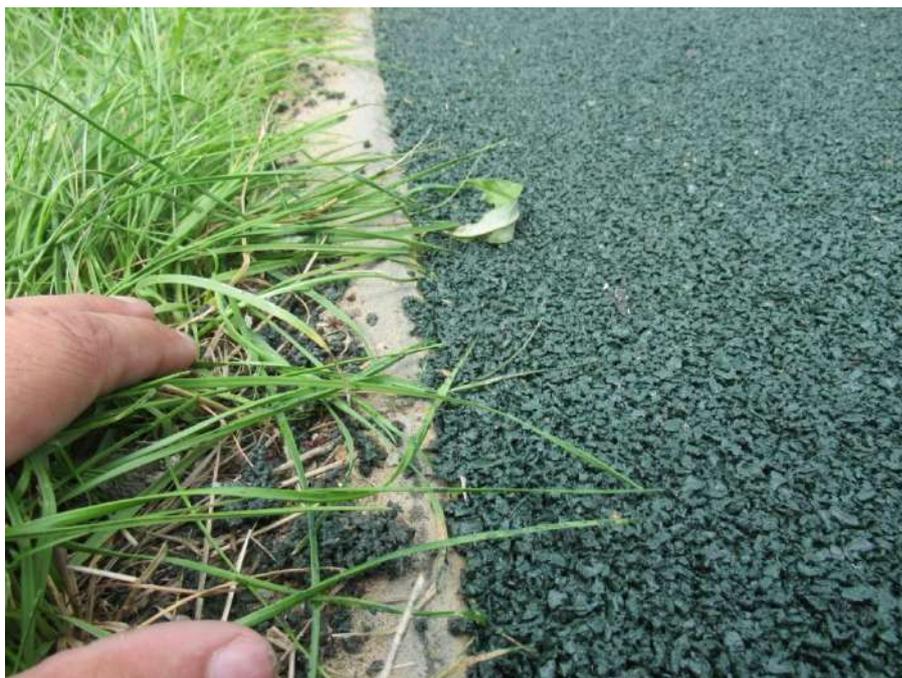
Крупный план участка примыкания универсального покрытия к бортовым камням на спортивной площадке. Зеленые стебли травы проросшей на газоне прилипли полиуретановому связующему в зазоре между бортовым камнем и резиновым покрытием.
